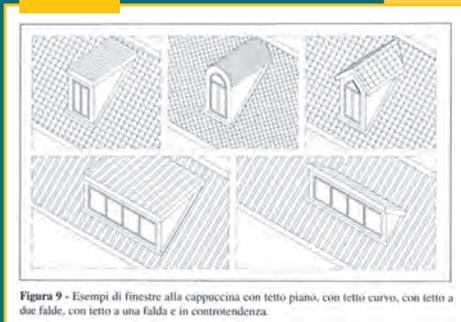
Esempi di finestre alla cappuccina con tetto piano, con tetto curvo, con tetto a due falde, con tetto a una falda e in controtendenza.
